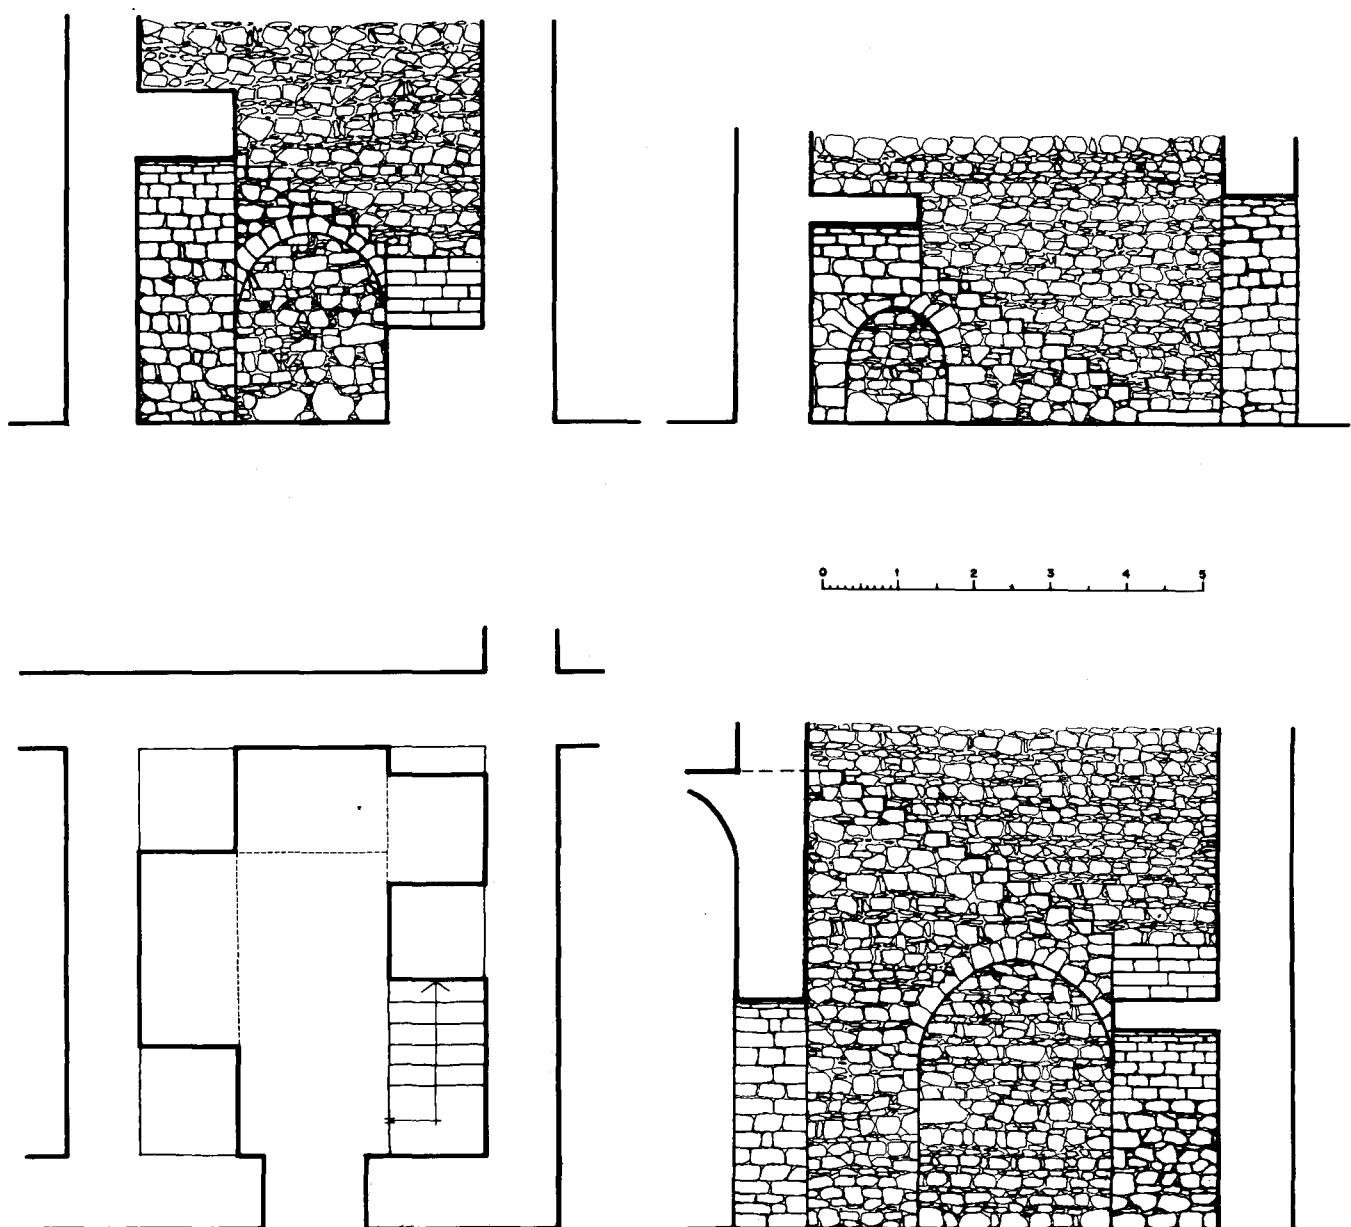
Planta y alzados reconstruidos de una escalera de los edificios omeyas del área del témenos.
